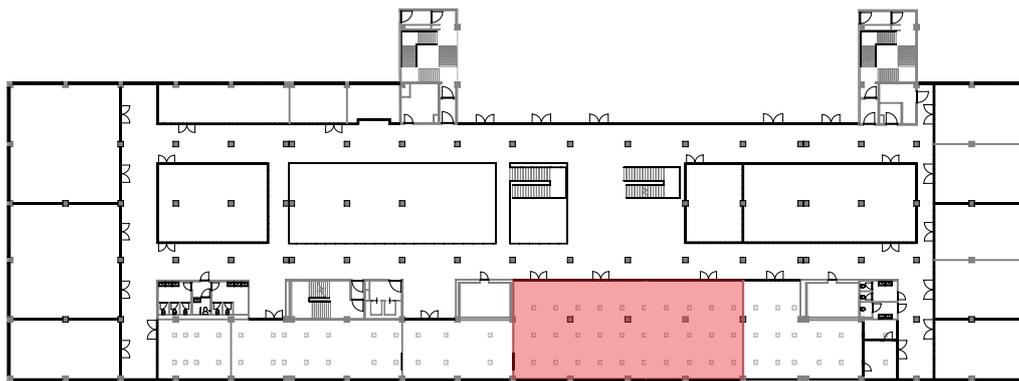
PIANTA PIANO SECONDO SDF - FOCUS 1
